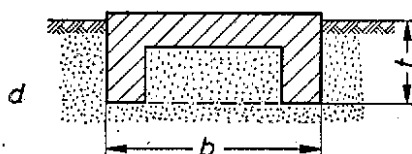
Maßgebende Längen für den Grundbruchnachweis bei unregelmäßigen Fundamentformen
